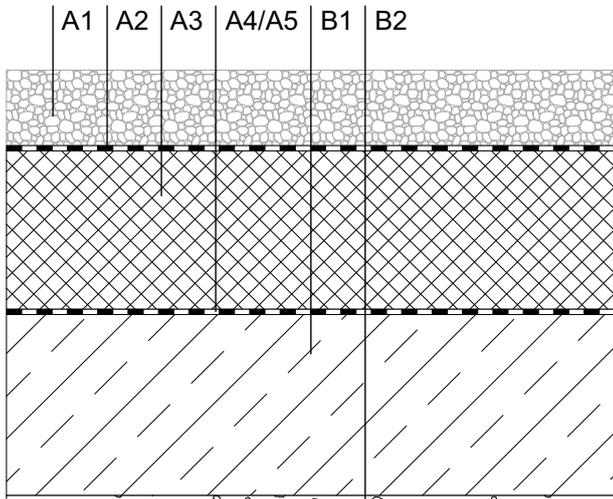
Vertikalschnitt Flachdachaufbau DA1, M 1:10
